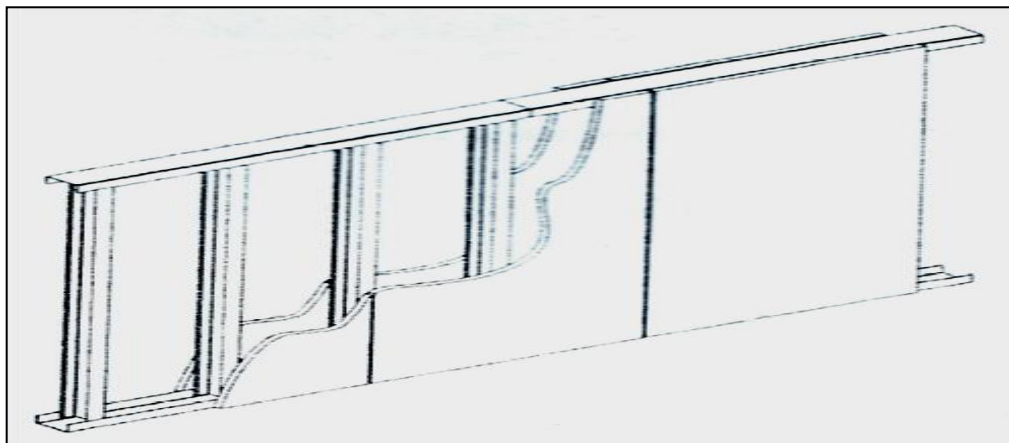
Esquema de fachada com sistema *steel frame* e placas cimentícias (Pini, 2008).
